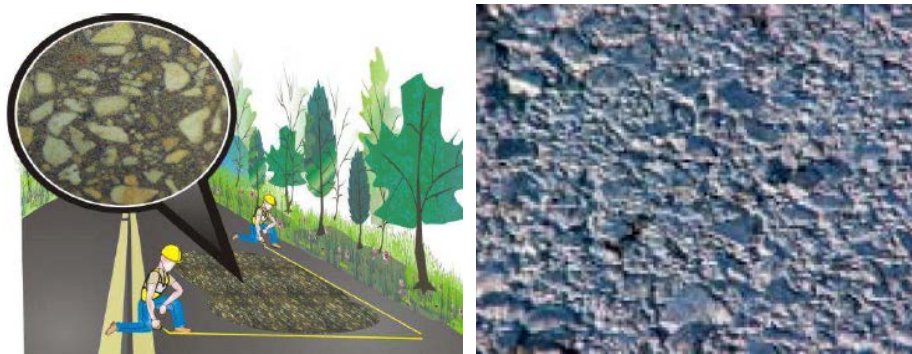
Apariencia de un pavimento afectado por Pulimento.
